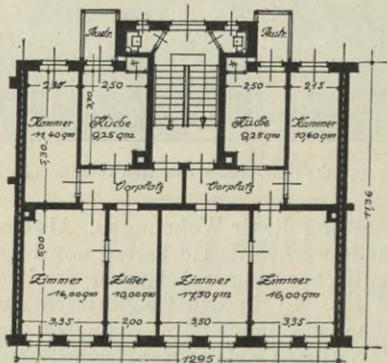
Typisches dreigeschossiges Sechsfamilienhaus in Sachsen (freistehend oder eingebaut)
